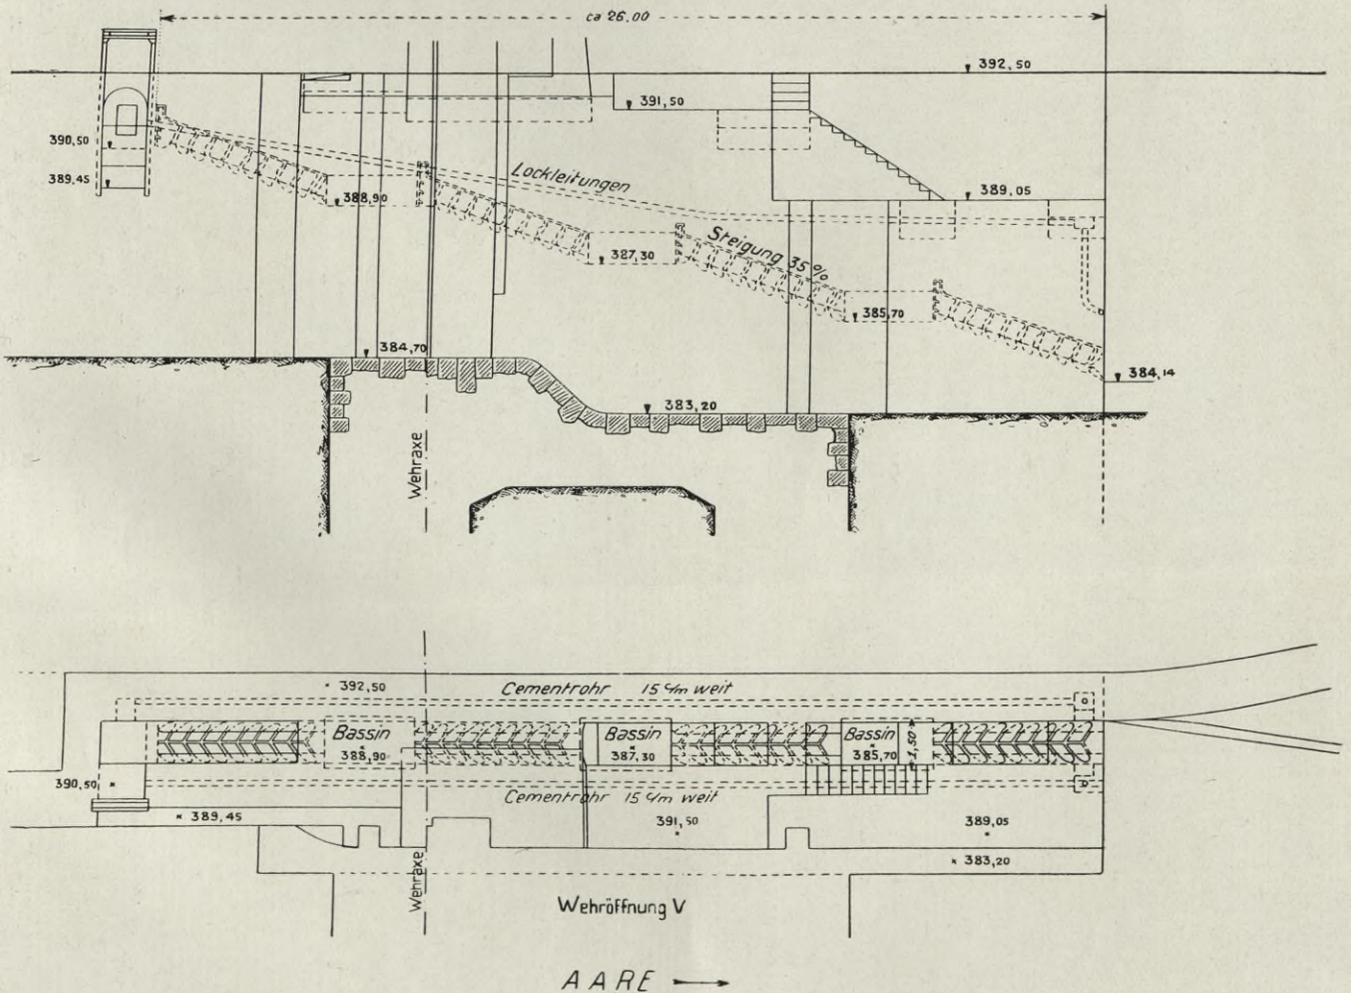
Stauwehr des Elektrizitätswerkes Olten-Gösgen. Grundriss und Längsschnitt durch die Denil-Fischtreppe. Maßstab 1 : 200.
